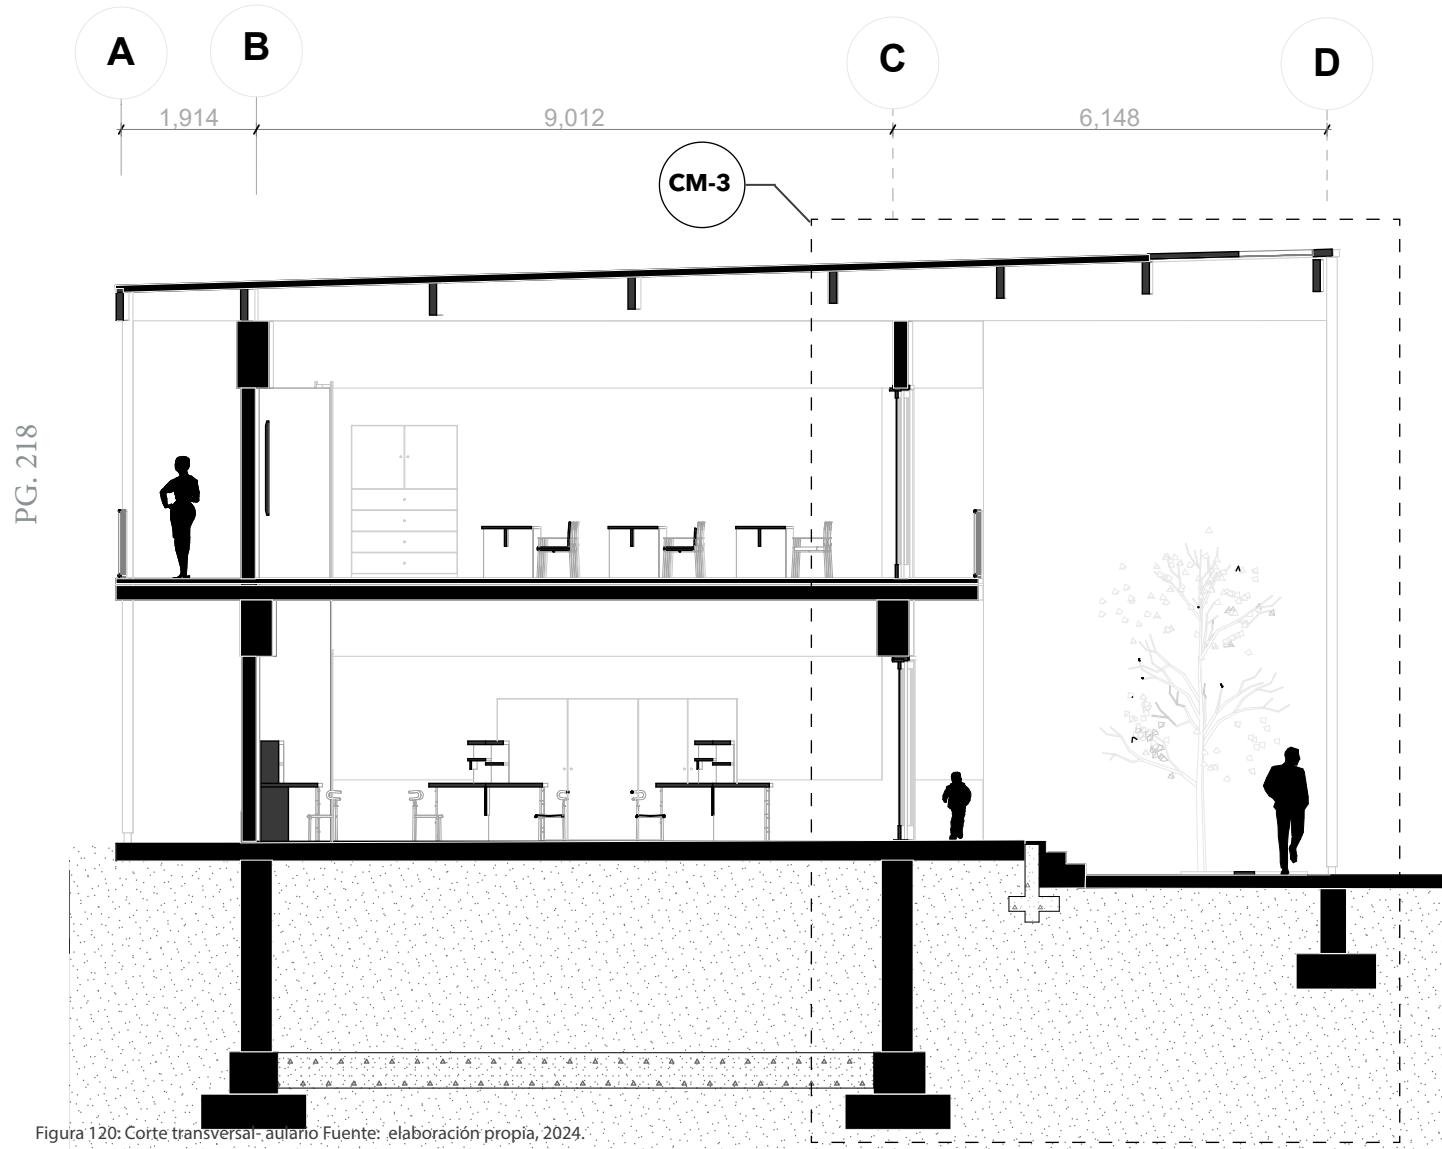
Corte transversal-aulario Fuente: elaboración propia, 2024.
